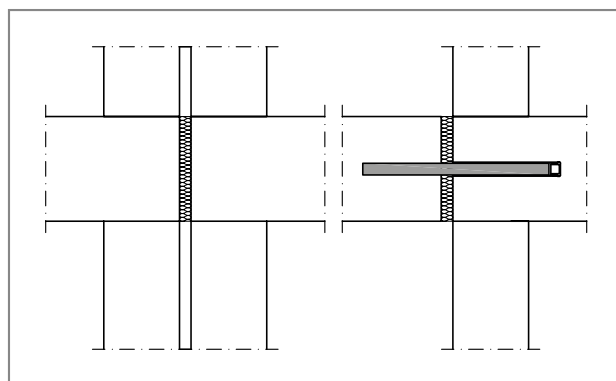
giunto di dilatazione con il sistema a perno Schöck invece di un doppio pilastro o parete
